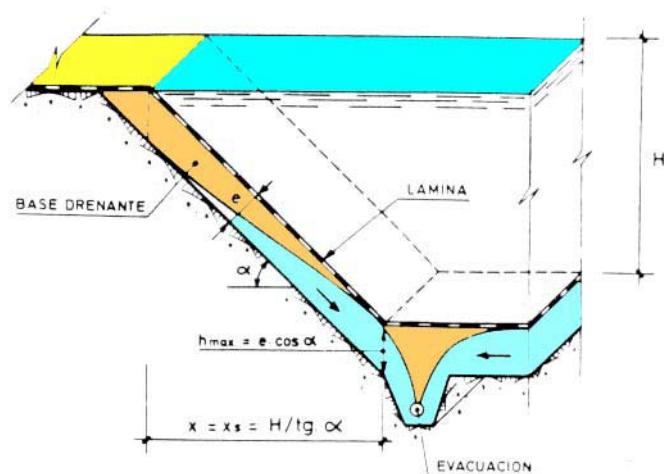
Base drenante en talud plano con punto de saturación en el pie.
